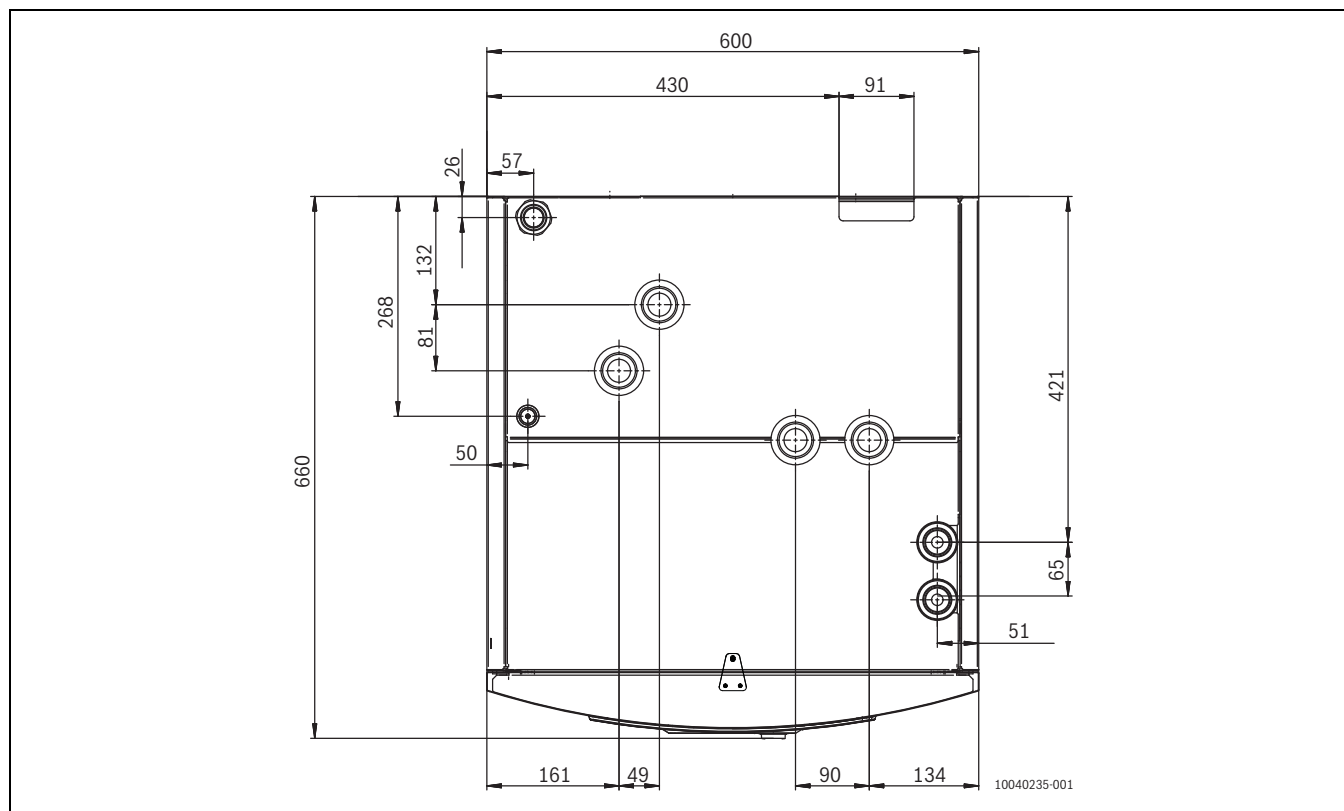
Dimensions du panneau de raccordement, vue de dessus
